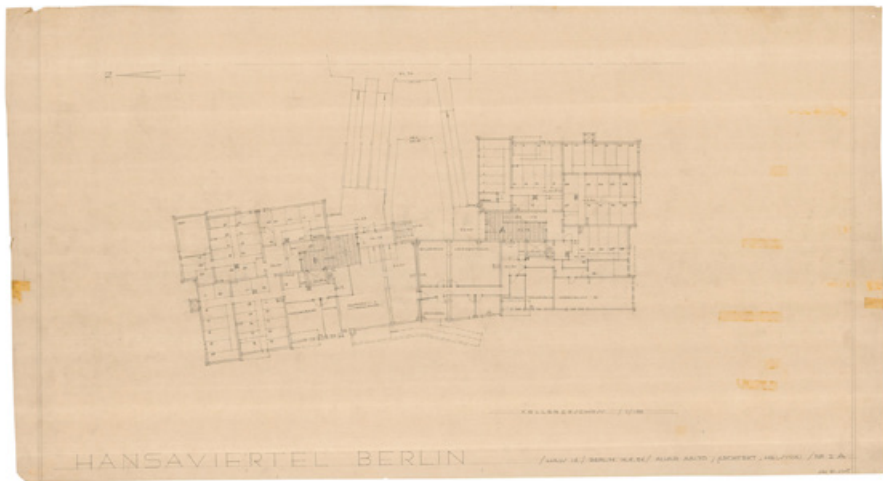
Alvar Aalto et Karl Fleig, *Haus 16, 1, Wohnungsgeschoss, n°3*, Hansaviertel, Berlin, 6-27 février 1956. Plan de sol, 1/100, graphite sur papier. Fondation Alvar Aalto, Helsinki et Jyväskylä, AAA83-2308.
